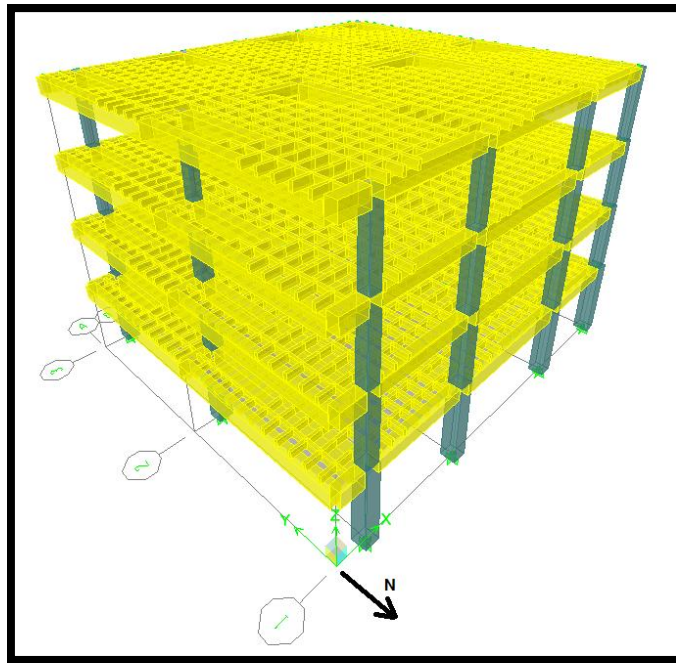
Vista 3D Módulo 1 (Fachada Norte y Lateral Este)
